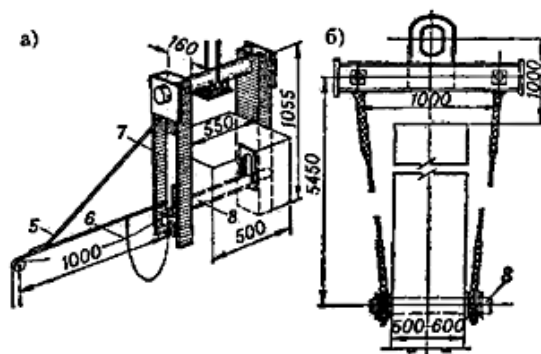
Штыревые захваты для железобетонных колонн: а) штыревой захват с дистанционным управлением; б) то же с местной расстроповкой; 5 – кронштейн; 6 – тросик для расстроповки; 7 – корпус захвата; 8 – запорный штырь
